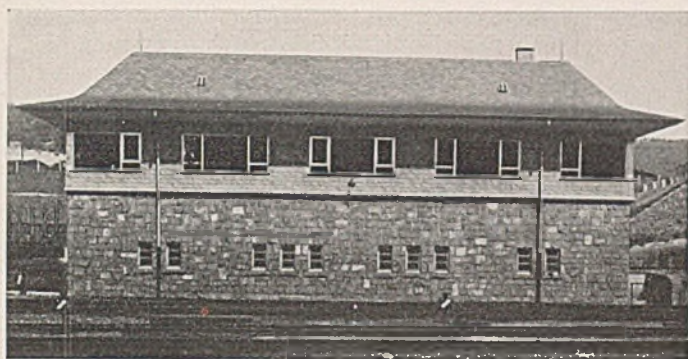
Beschiefertes Fachwerk mit Steildach über Bruchsteinsockelgeschoß.
